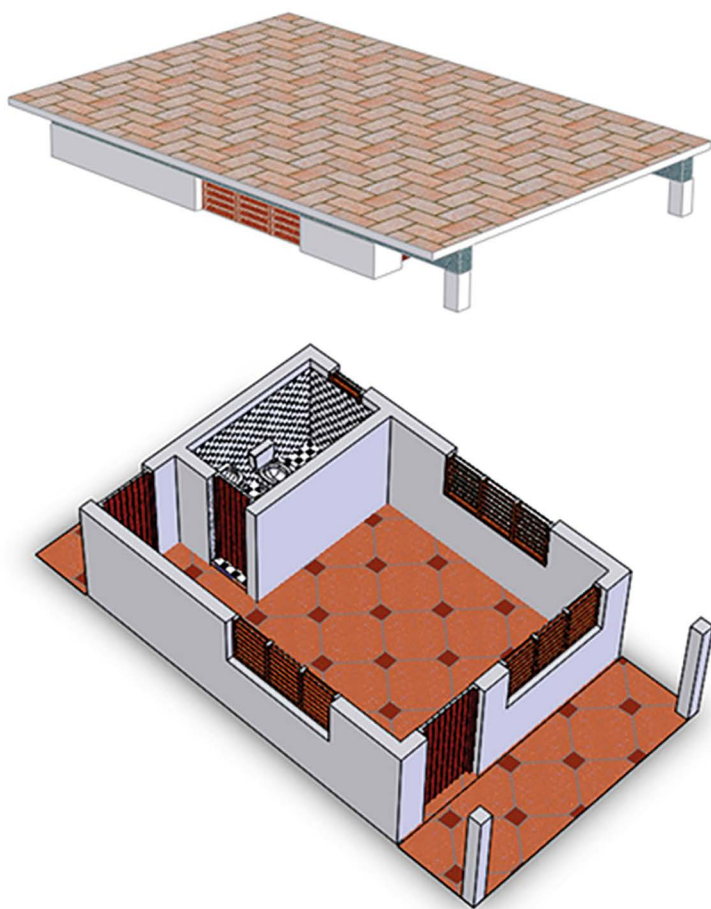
Corte horizontal imaginario para el plano de planta de la vivienda
